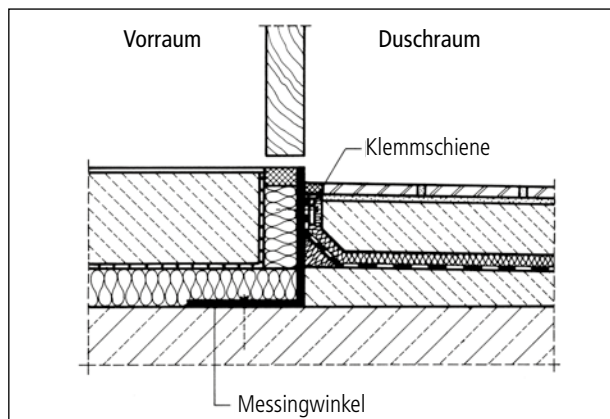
■ Abdichtungsabschluss im Türbereich – Detail
